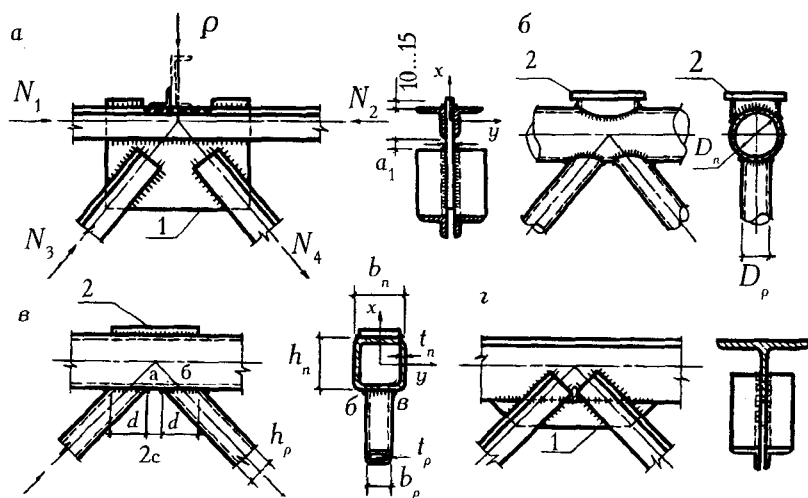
Узлы ферм: а — из двух уголков; б — из круглых труб; в — из прямоугольных труб; г — с поясами из тавров; 1 — фасонка; 2 — распределительная деталь
